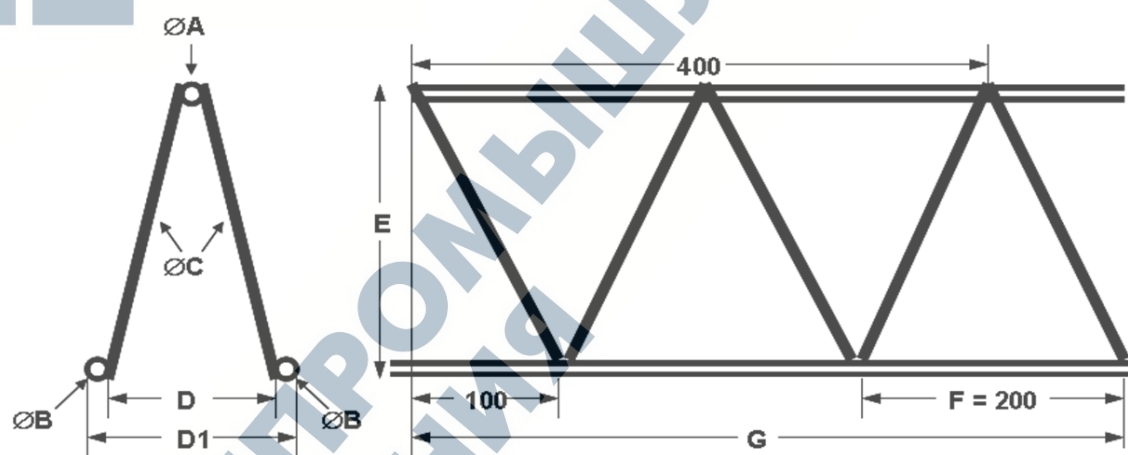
Каркас треугольный электросварной (КТЭ)
